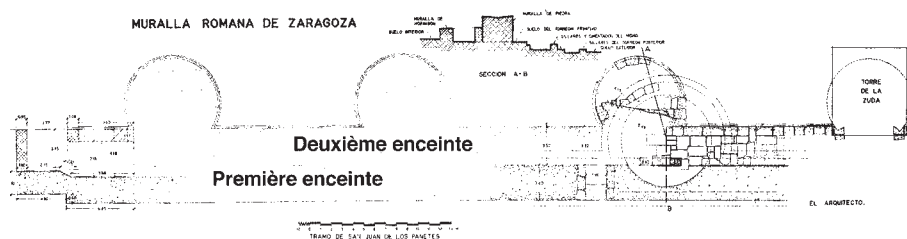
Saragosse : plan de la superposition du mur de fondation et du mur tardif (d'après Iñiguez 1959).
